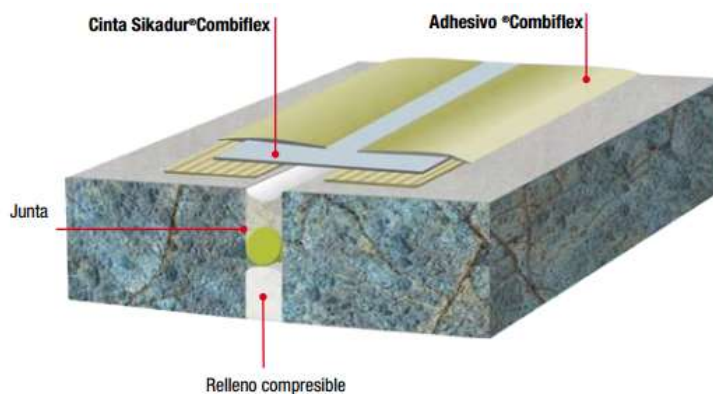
8 Detalle de Sellado de Junta. Fuente: www.seka.com.
